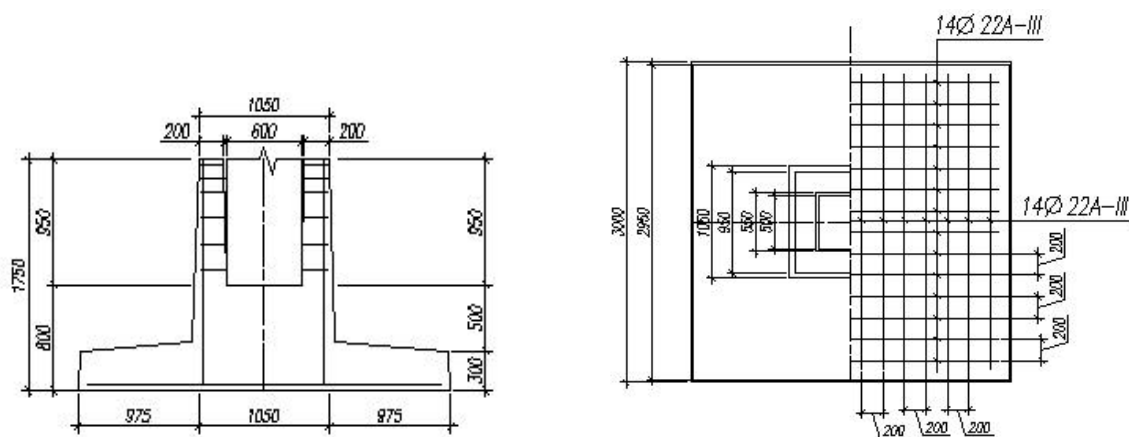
Геометрические размеры и армирование железобетонного фундамента под средние ряды колонн каркаса.
